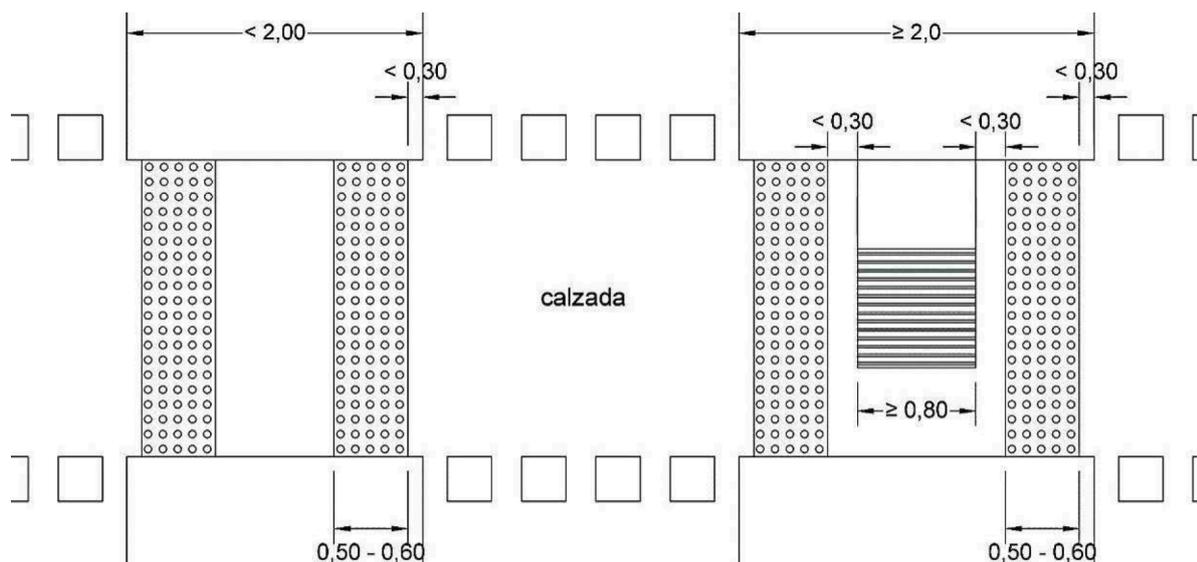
9. Ejemplos de pavimentación táctil en isleta intermedia
